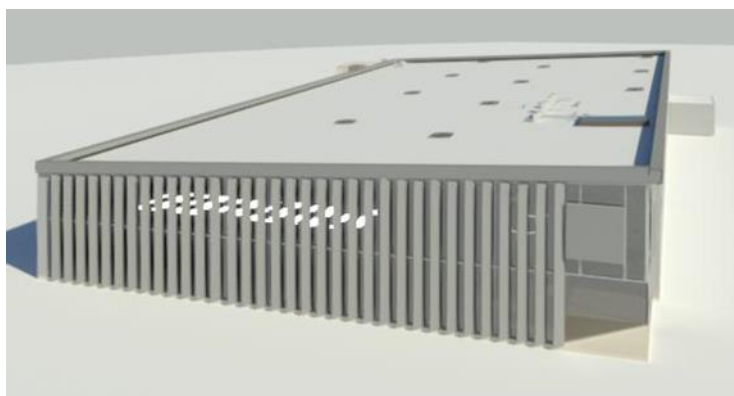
Vista exterior do supermercado com as *brise-soleils* verticais.
